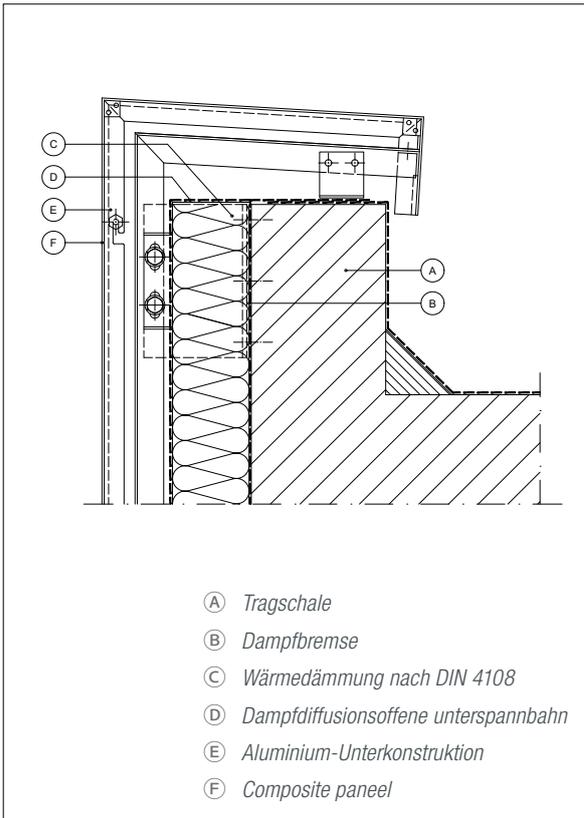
Composite Kassettensystem Fassadenanschluss oben
